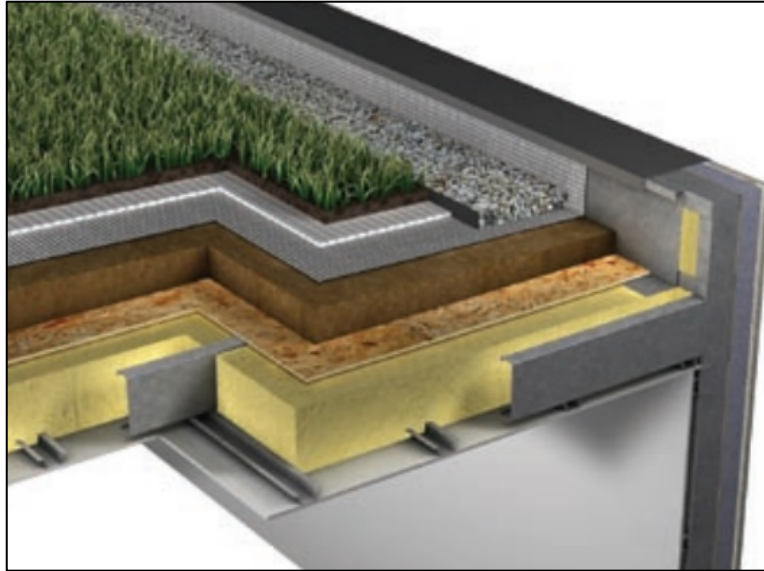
Cubierta tipo Terraza (Gravilla o Vegetación)
